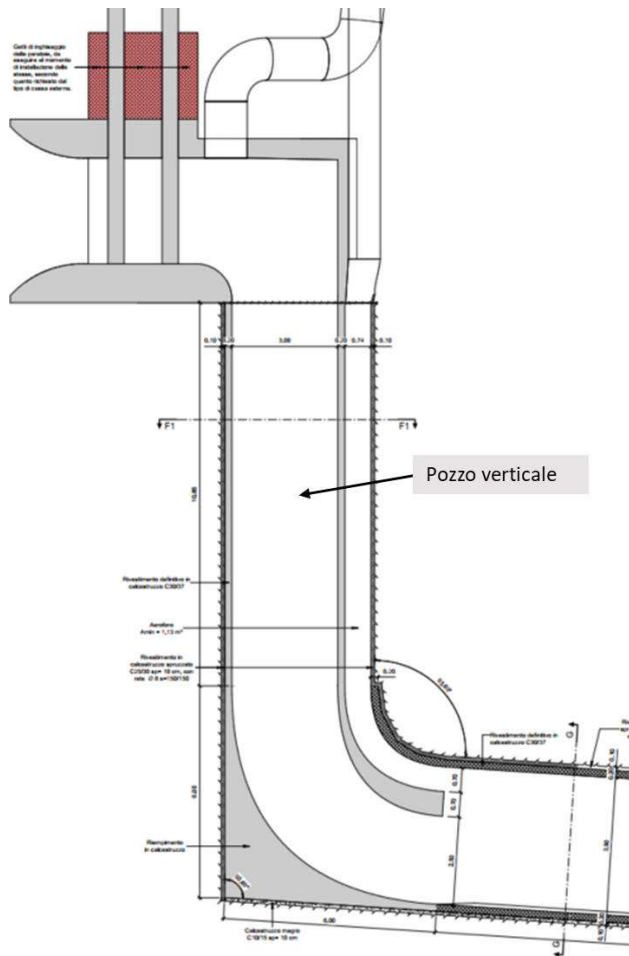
Pozzo verticale di collegamento tra la bocca di presa e la galleria di connessione scavato con la tecnica del raise boring
